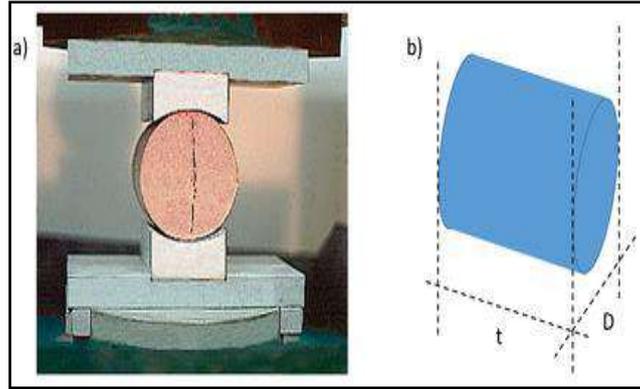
Falla por tracción indirecta en un cilindro de concreto. [54]
